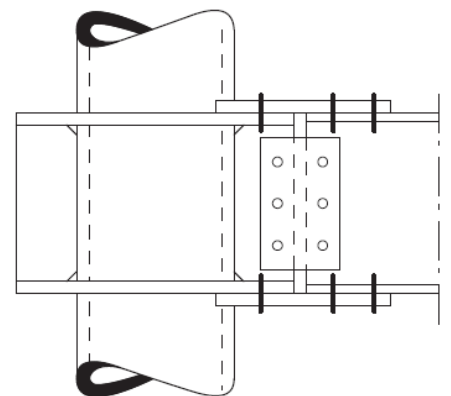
Raccordement d'une poutre à un poteau avec goussets sur les tubes.
